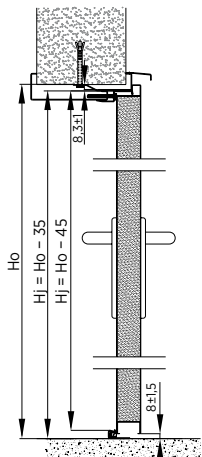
Montage mural d'un bloc-porte à un battant avec bâti enveloppant - coupe verticale
